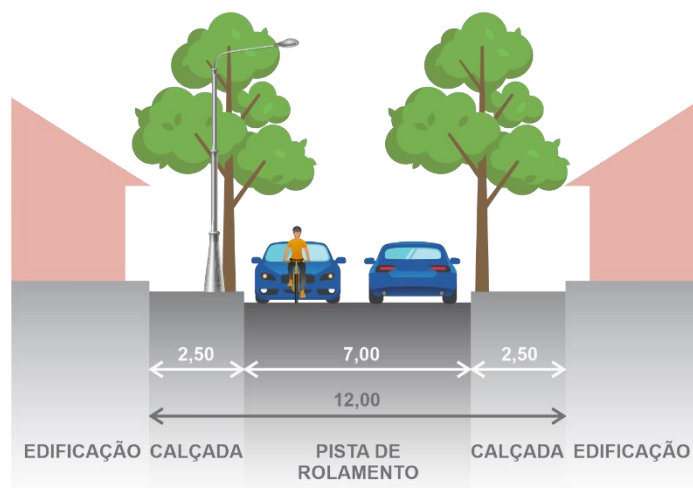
Via Coletora Tipo 2: estrutura e dimensões
